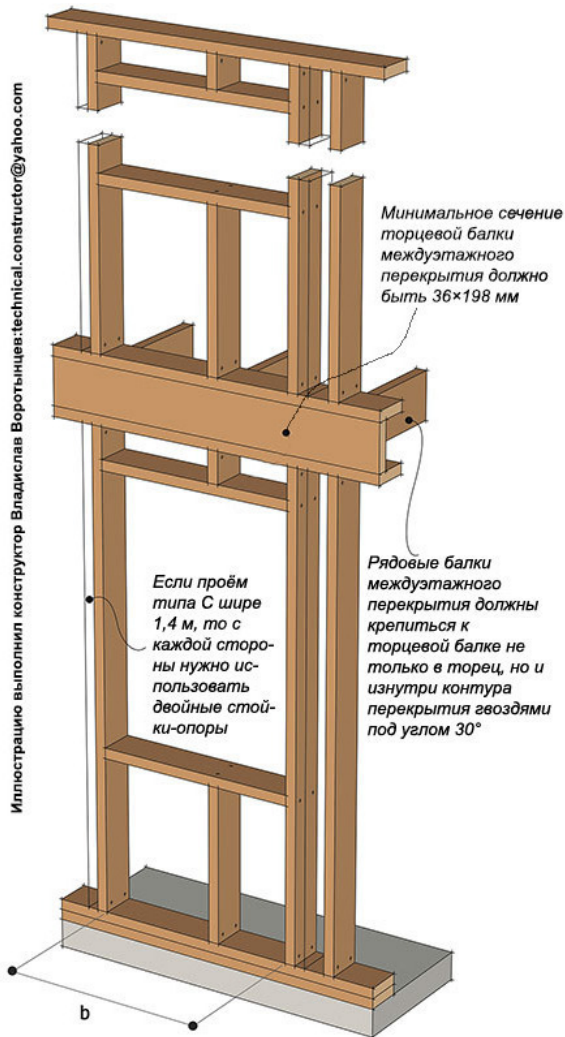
Проём в несущей стене с нагрузкой только от междуэтажного перекрытия. Проём типа С
